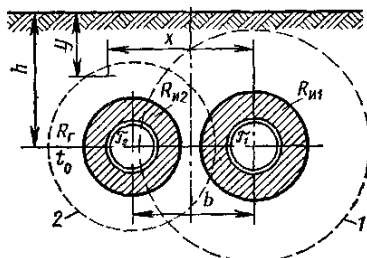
Расчетная схема бесканального двухтрубного теплопровода
